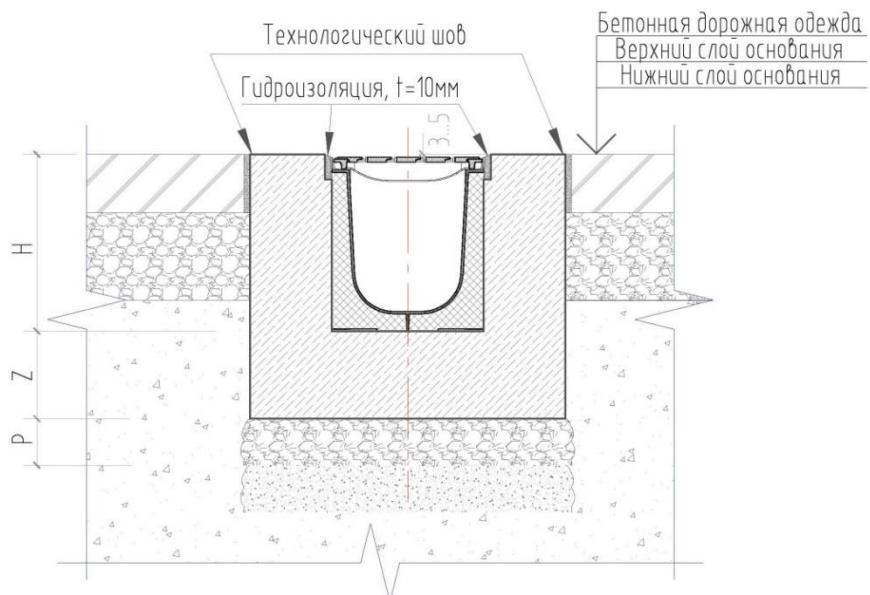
Монтаж пластиковых лотков с бетонным покрытием для высоких классов нагрузки от D400 до E600.
